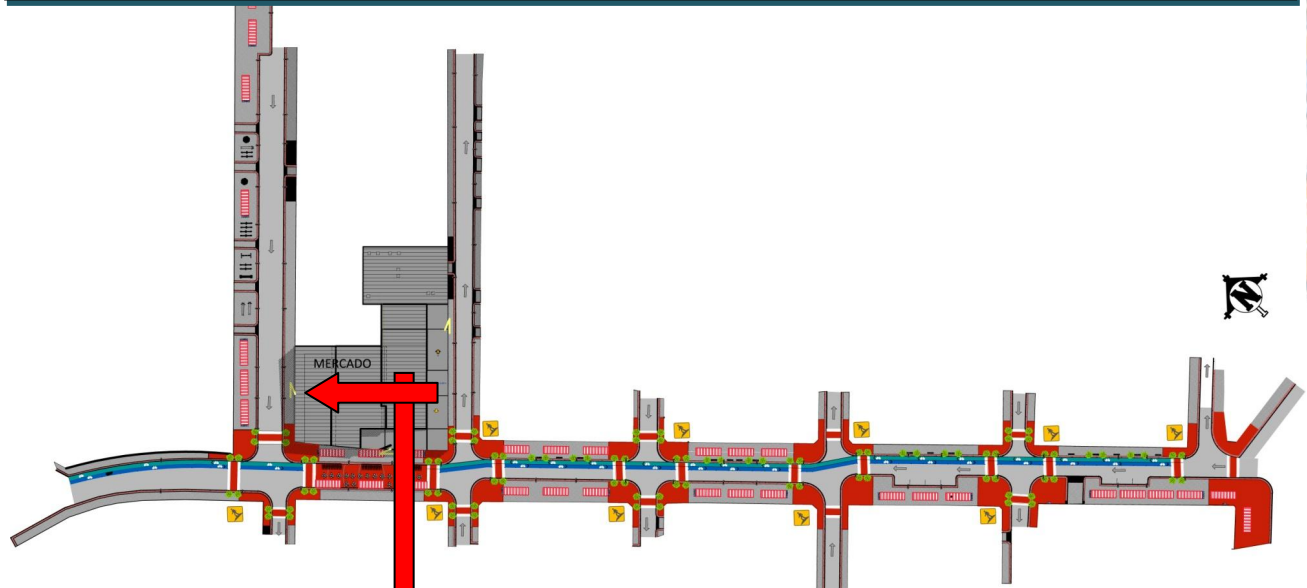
PLANTA DE REFERENCIA SECCIÓN 5
